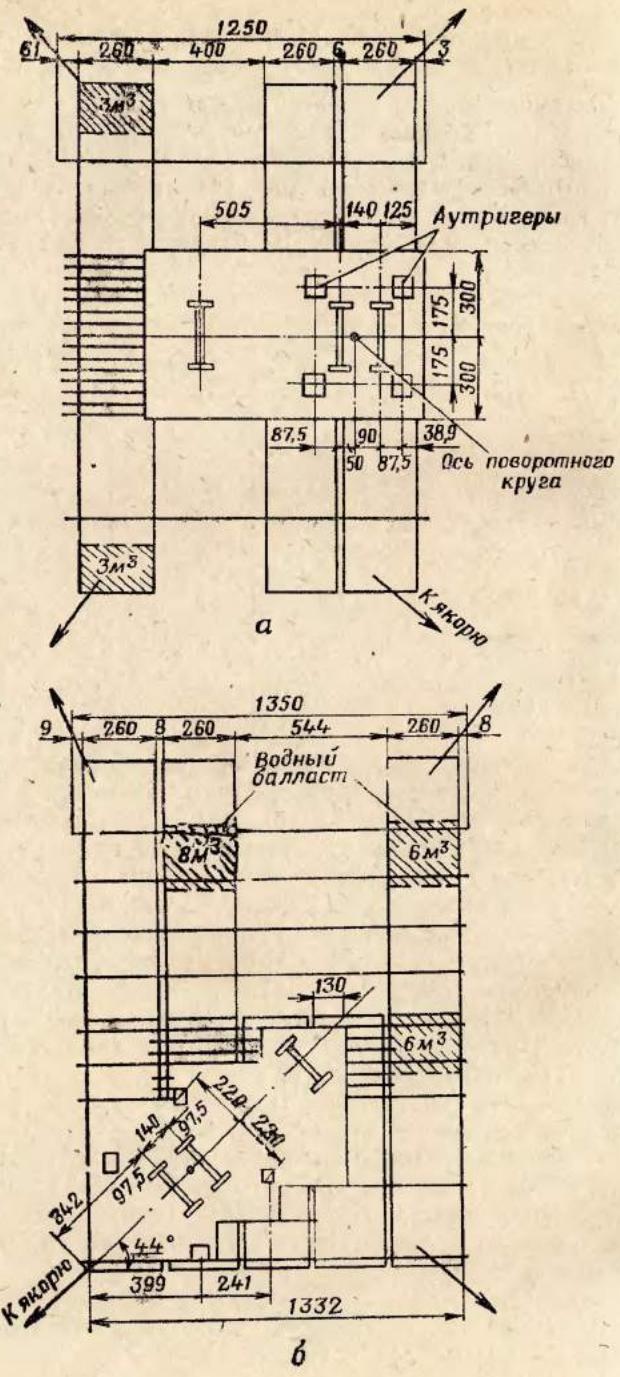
Плашкоуты из pontонов НЖМ-56 под крановое и копровое оборудование на К-104 и К-162:
